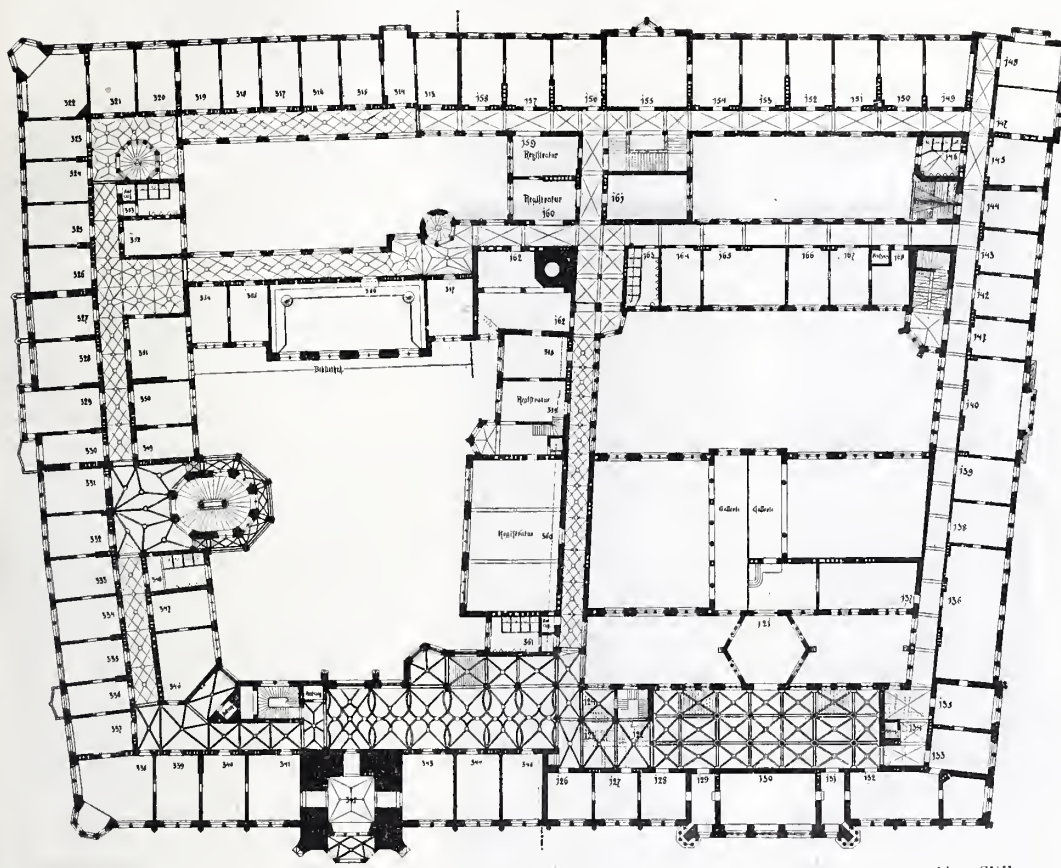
Grundriss vom III. Obergeschoss. — Masstab 1 : 800.
